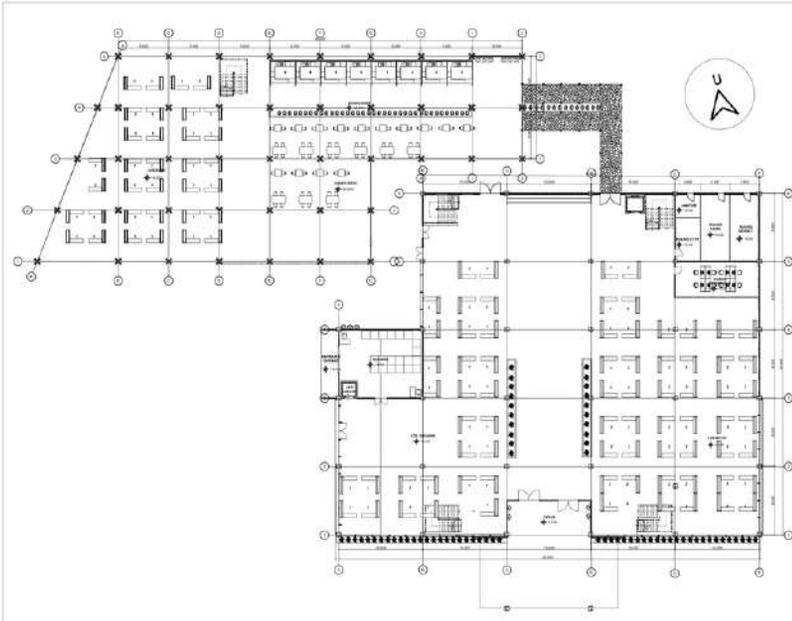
Skematik Denah Foodcourt Lt 1
